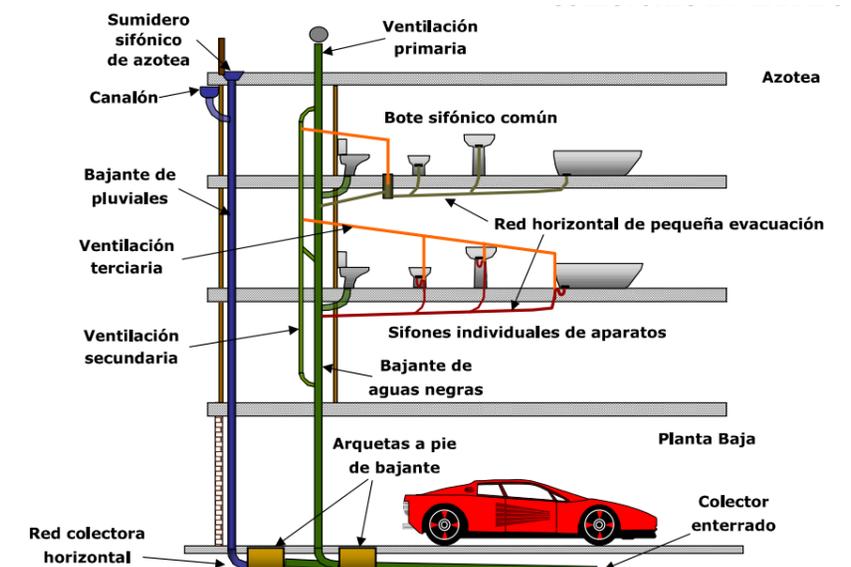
Esquema sistema mixto de saneamiento con colectores enterrados.
